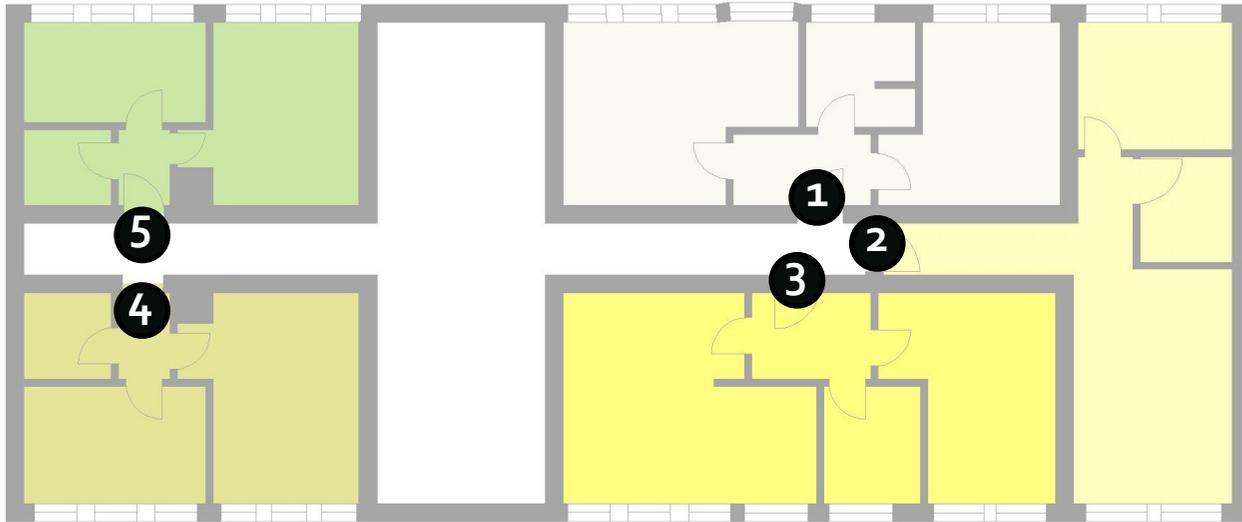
Geschossgrundriss Teil C, (2. - 13. OG)
